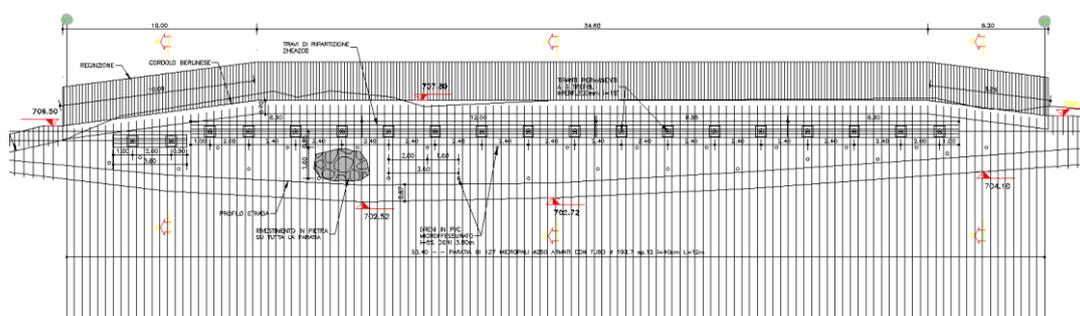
Prospetto berlinese di collegamento alla viabilità esistente
